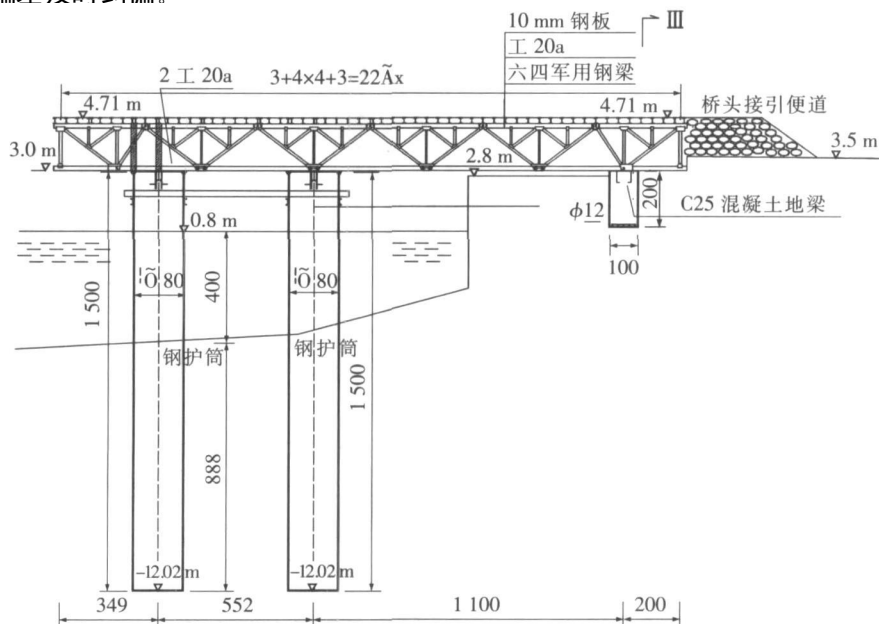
主墩施工基础平台纵向立面图 (单位: cm)
